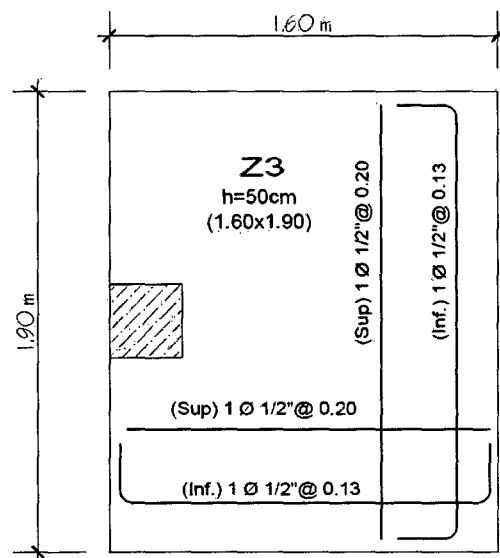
Distribución final del refuerzo para zapata Z-3.
